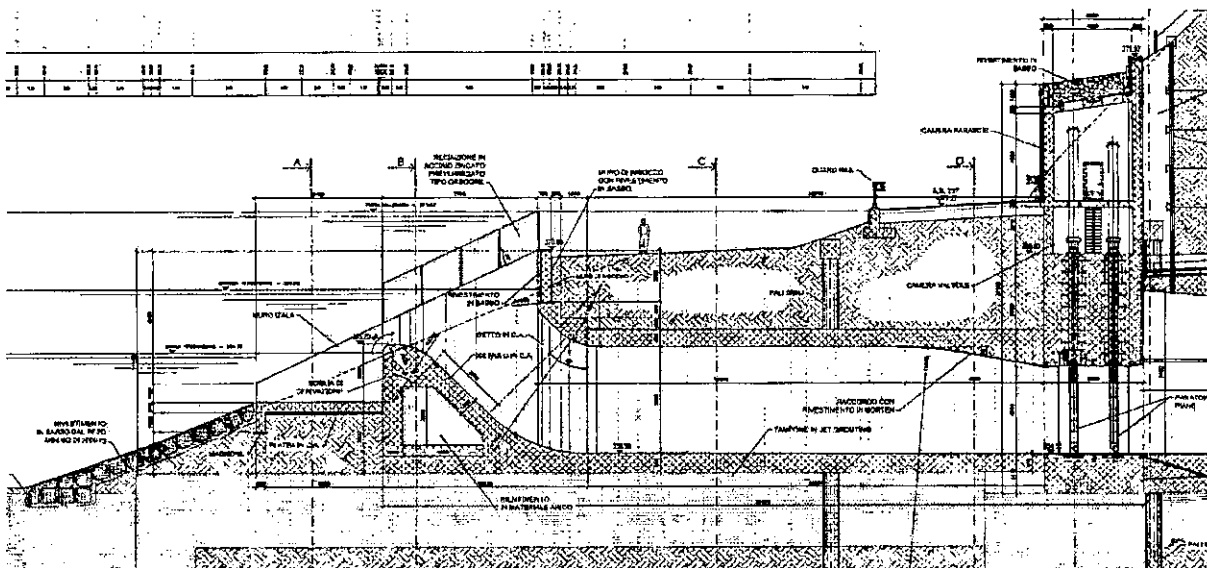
sezione imbocco galleria come previsto dal progetto definitivo sottoposto a VIA statale.
